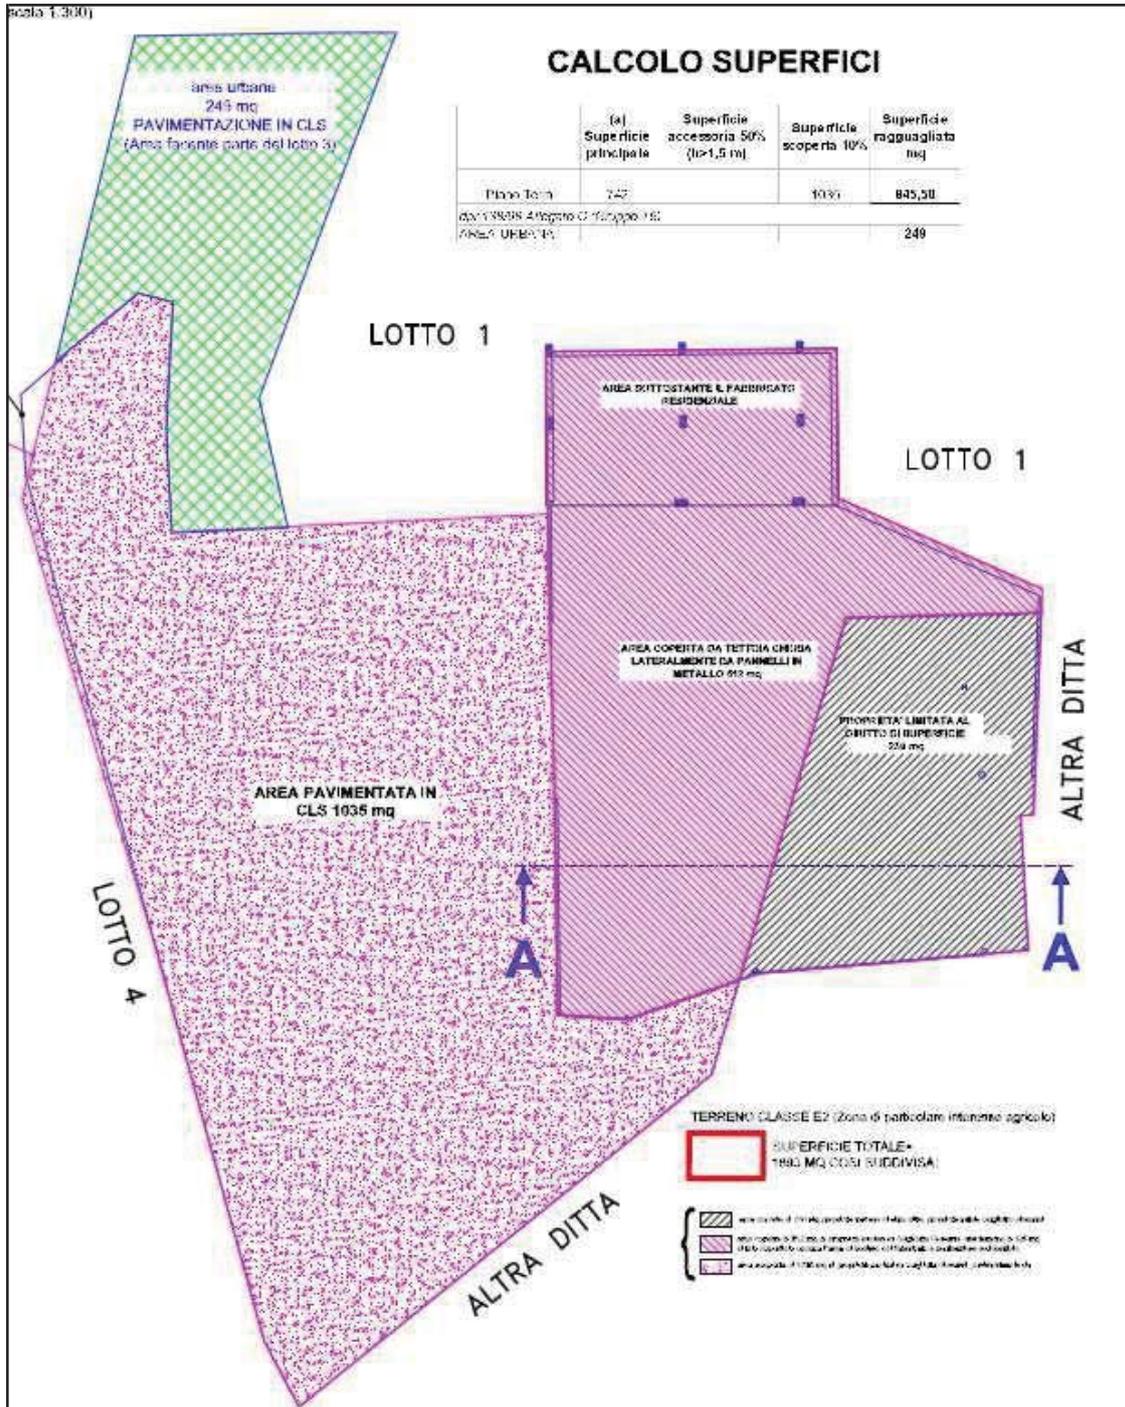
stralcio calcolo superfici lotto 3 Allegato 10
